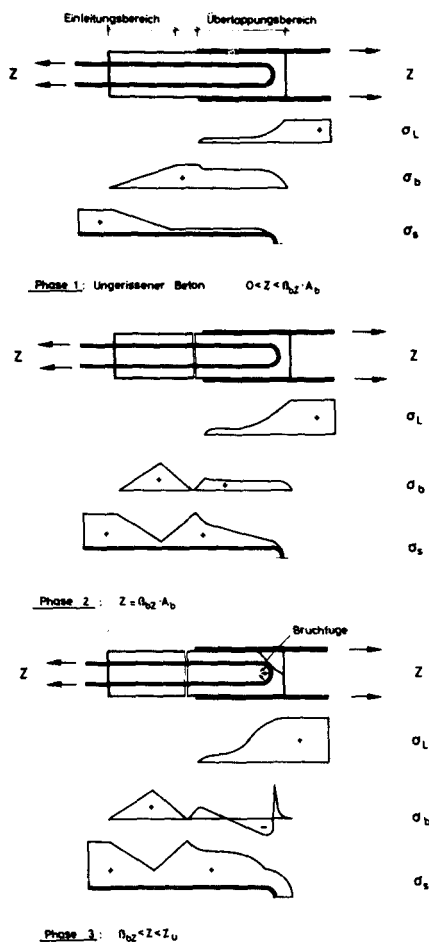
Verteilung der Normalspannungen in Lasche, Beton und Bewehrung (schematisch)
